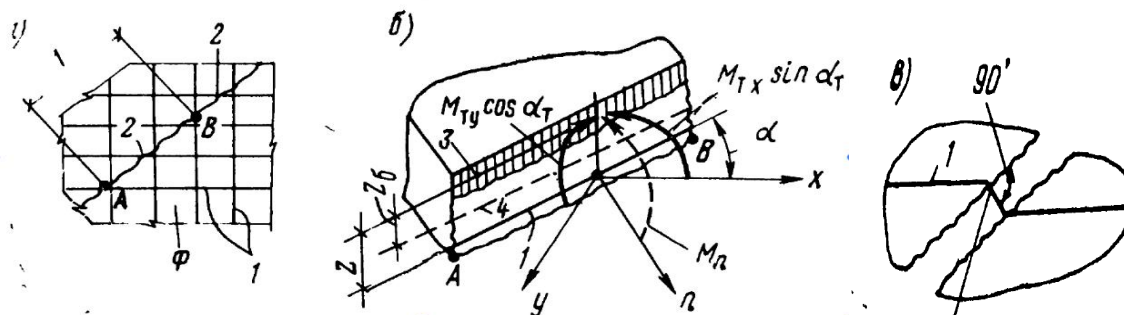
Различие в характере пластической деформации арматуры плит перекрытия в трещинах согласно теории Карпенко (а, б) и теории Вуда (в). 1 - арматура, 2 - линия текучести арматуры, 3 - зона сжатия, 4 - средняя линия плиты
